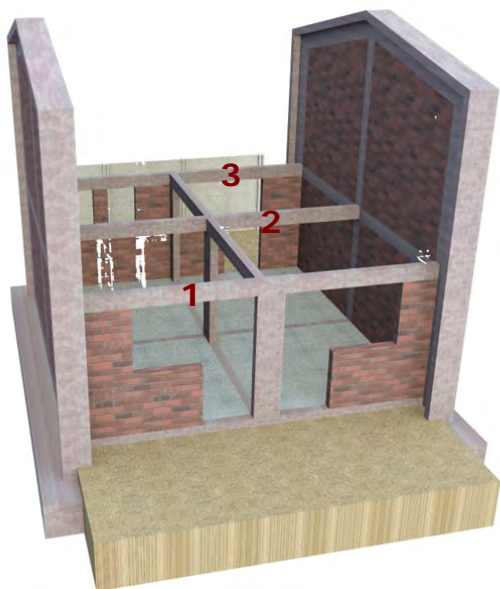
inclusión de las 3 Vigas (cadenas) de Hormigón Armado
